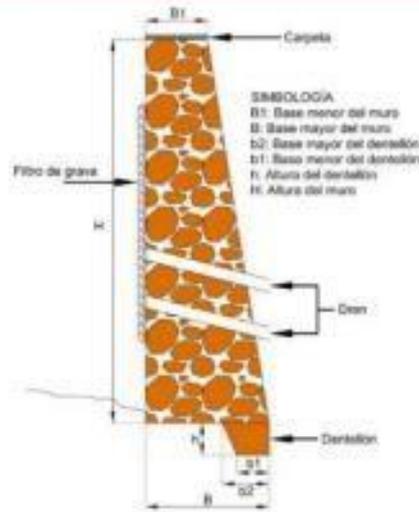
Componentes de un muro de contención de mampostería con dentellón
